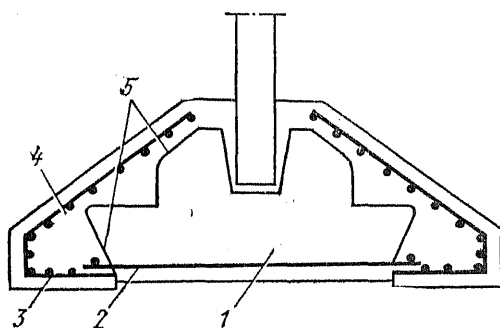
Расширение опорной площади и усиление отдельно стоящего фундамента
